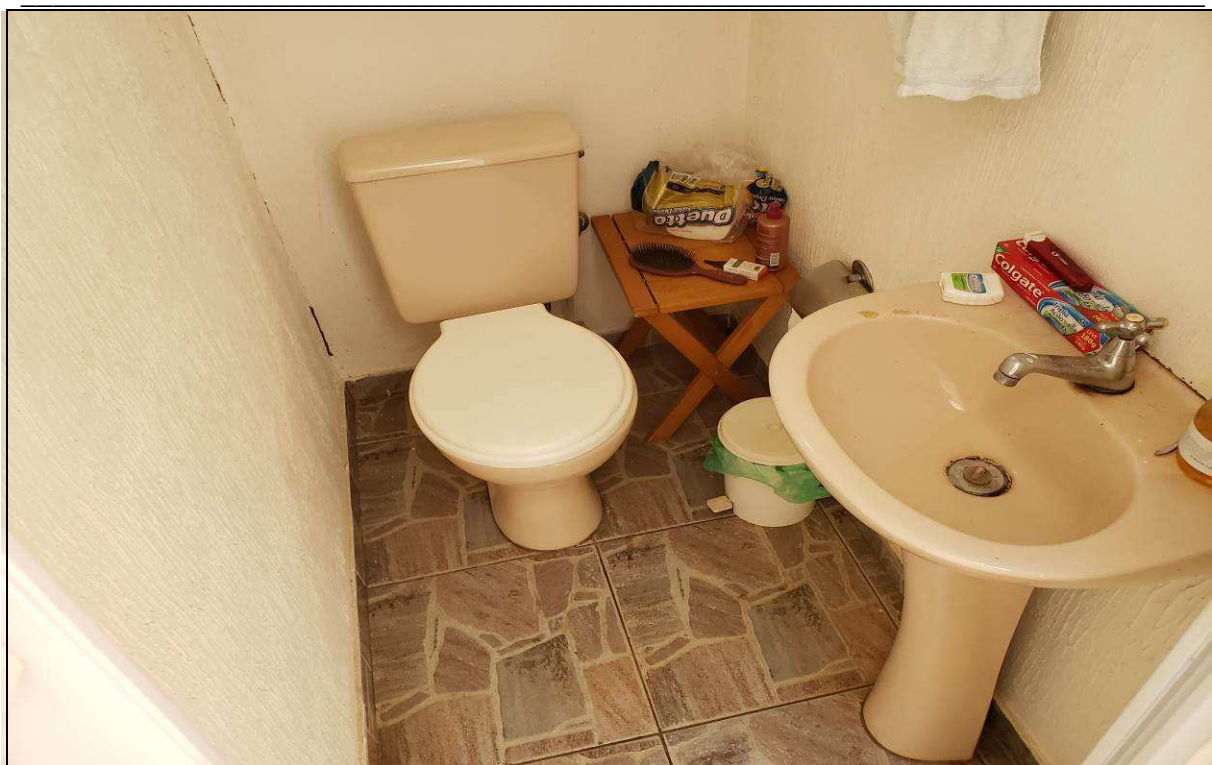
Vista geral do banheiro externo do imóvel avaliando.
